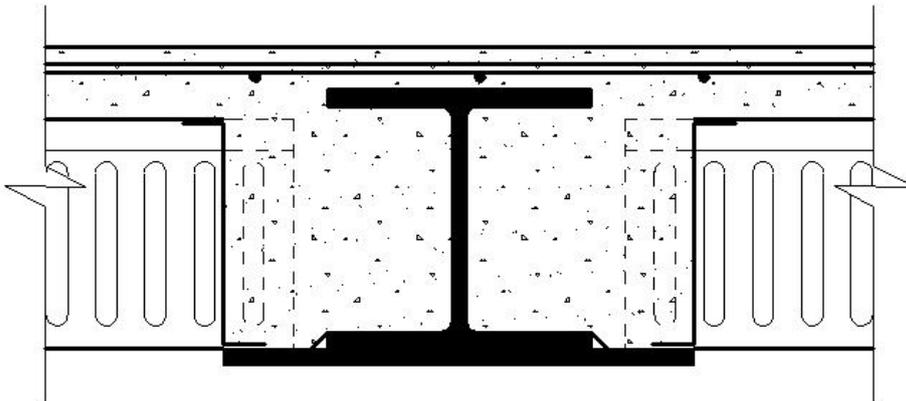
Poutre Slimfloor classique supportant une dalle mixte avec bac acier
